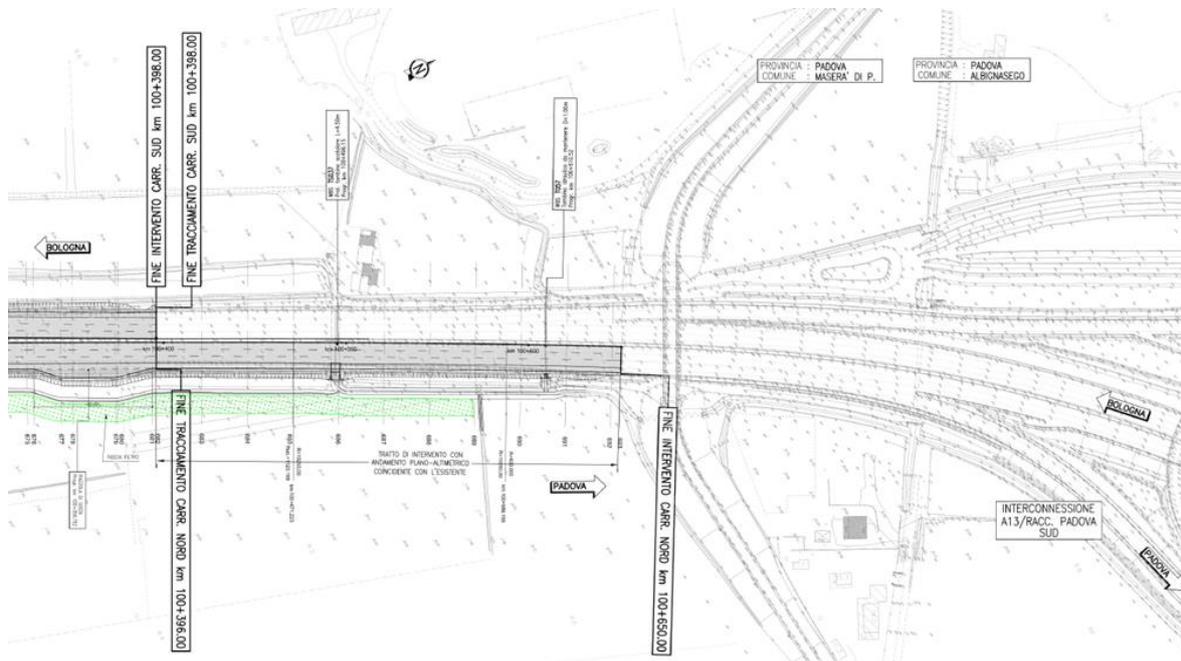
Interconnessione A13/raccordo Padova Sud - planimetria
